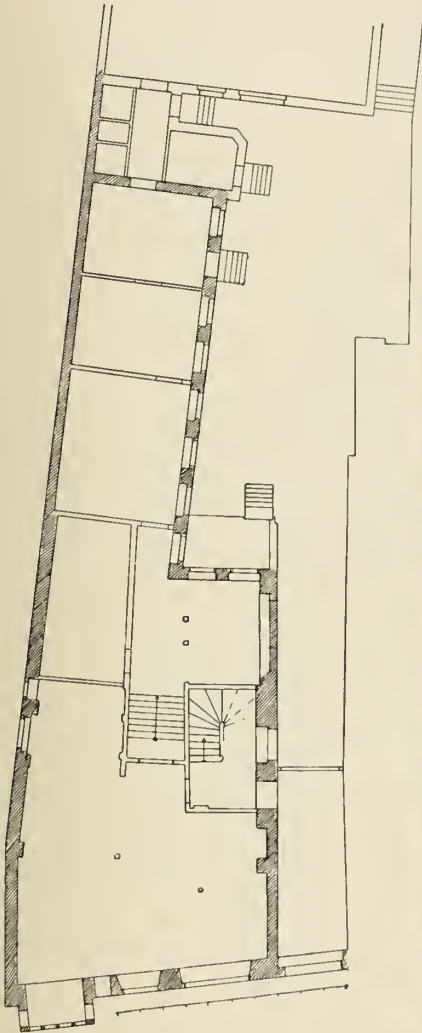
Hannover; Leinstraße 32, Grundriß.
